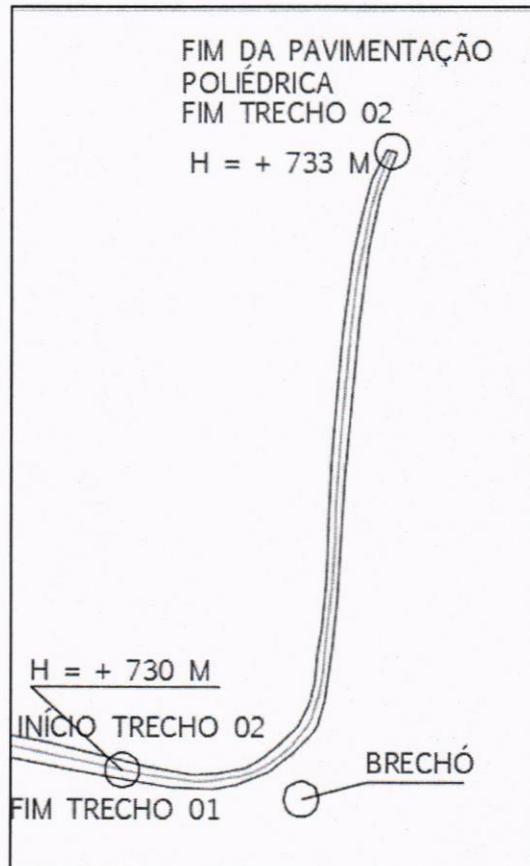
Perfil Longitudinal do Pavimento - Cruzamento
